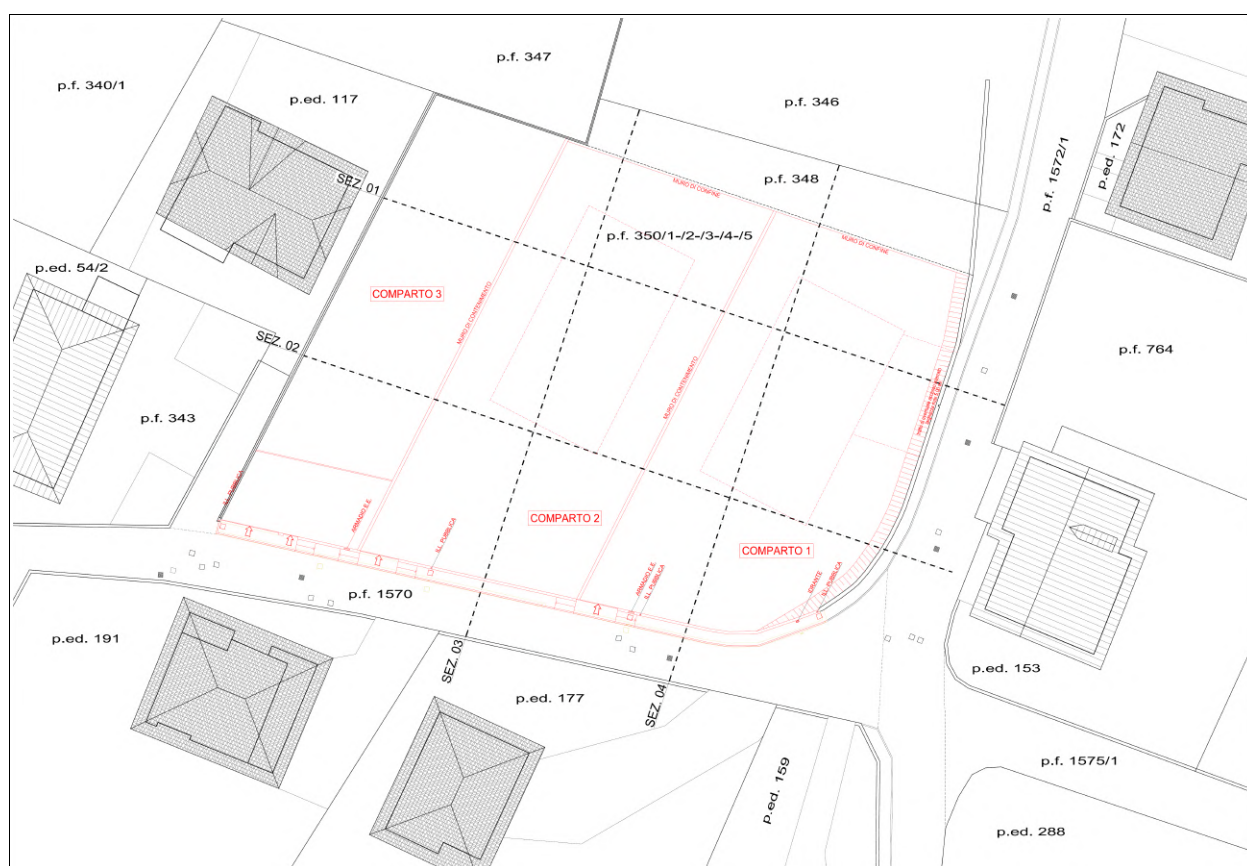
Estratto Planimetria di raffronto (Tav. 02) da progetto redatto dall'Arch. Italo Bertolini.
